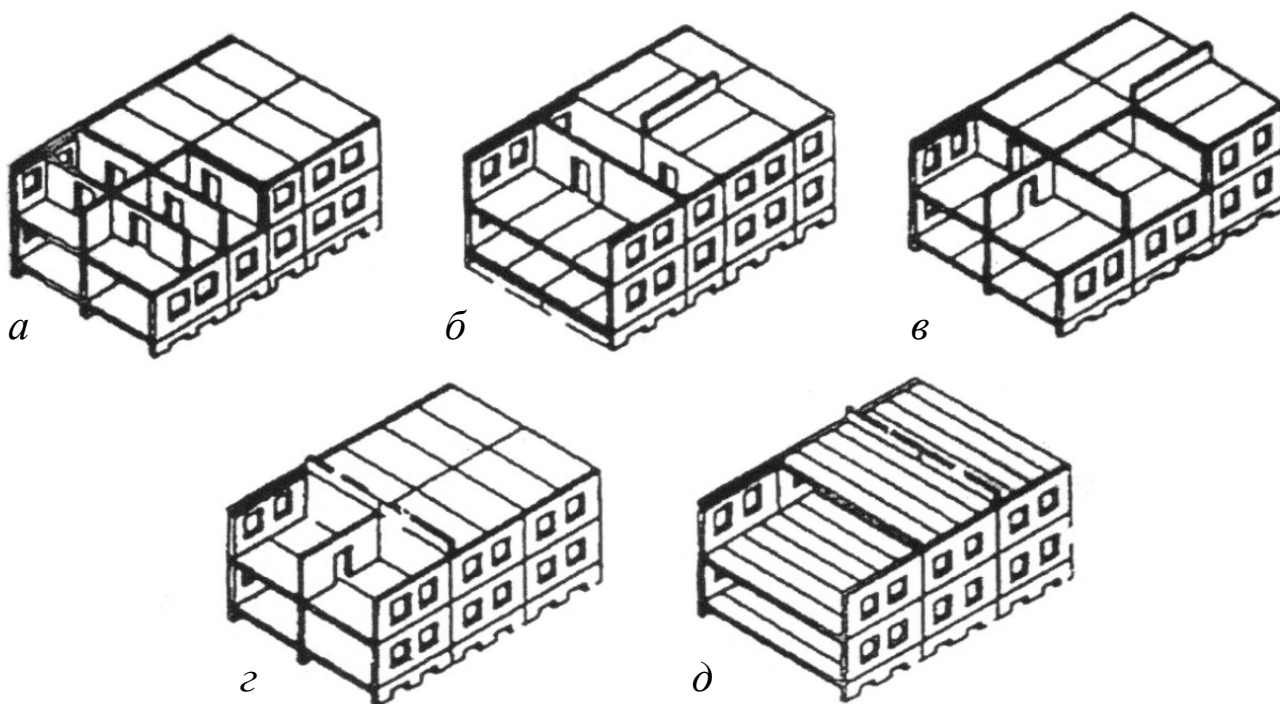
Конструктивные схемы бескаркасных зданий
